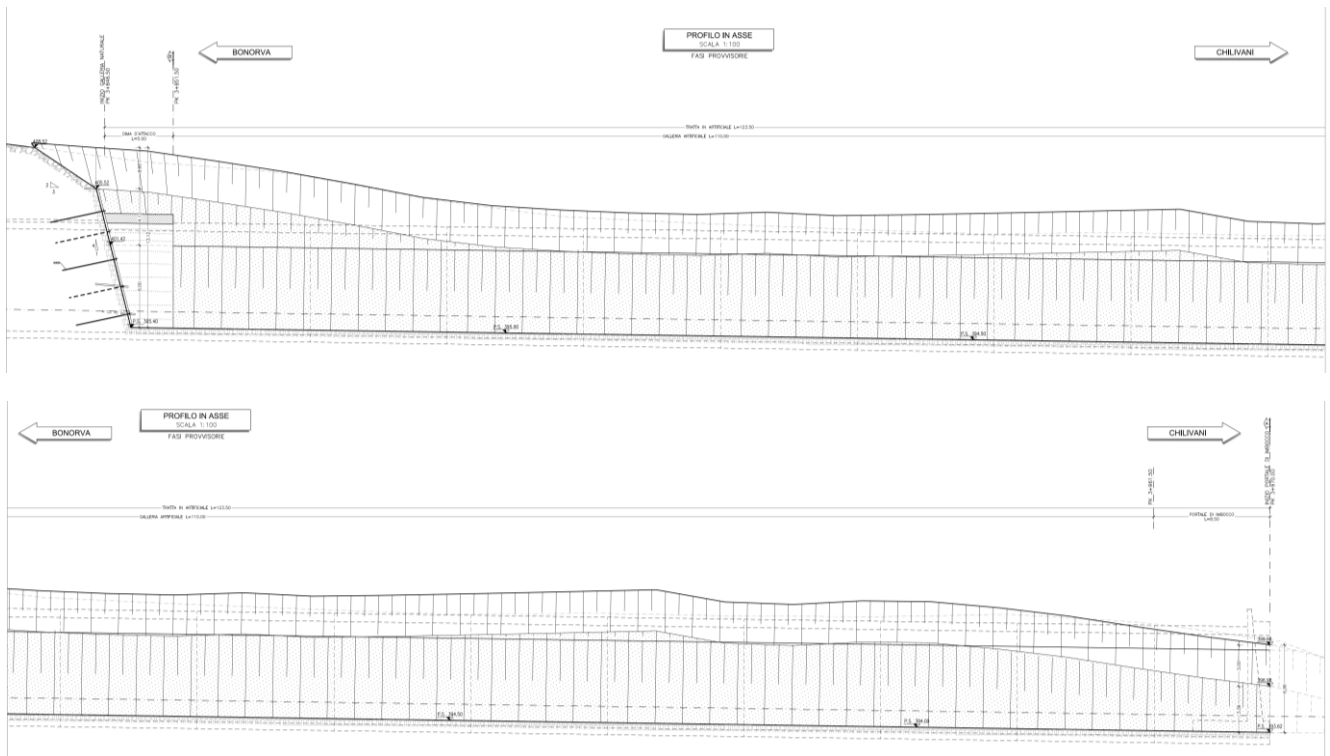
Galleria Giave – Imbocco lato Chilivani – Profilo in fase provvisoria
